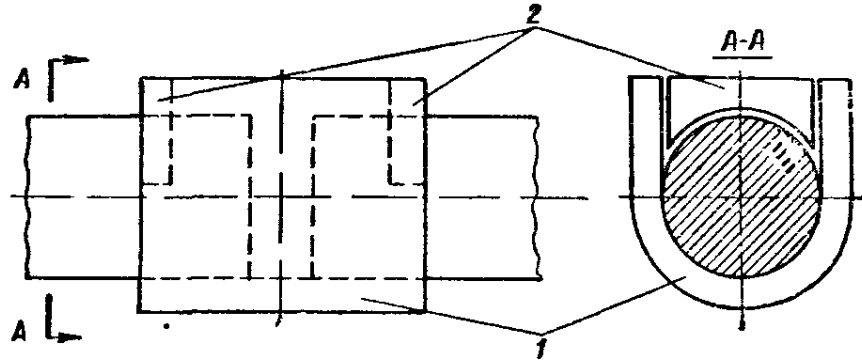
Ванный способ сварки стыков горизонтальных стержней
